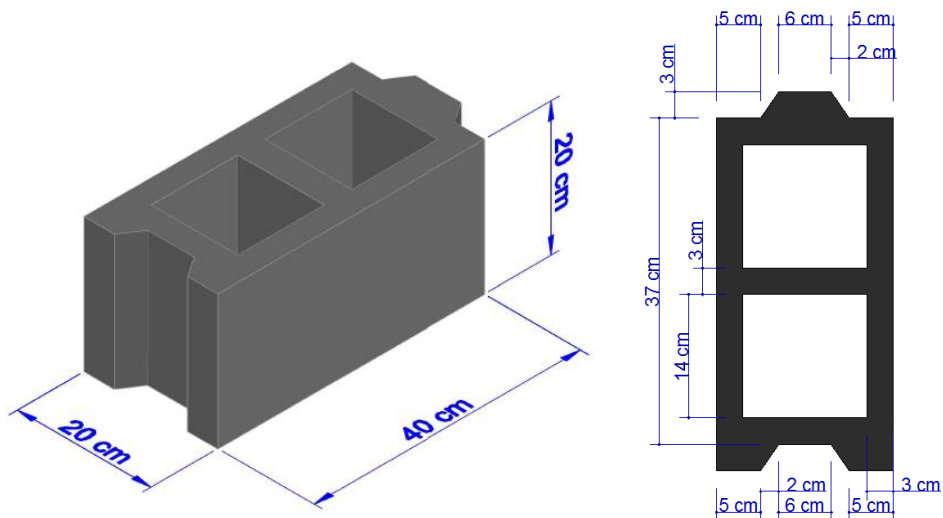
Dimensões em planta e em plano 3D dos blocos de betão
